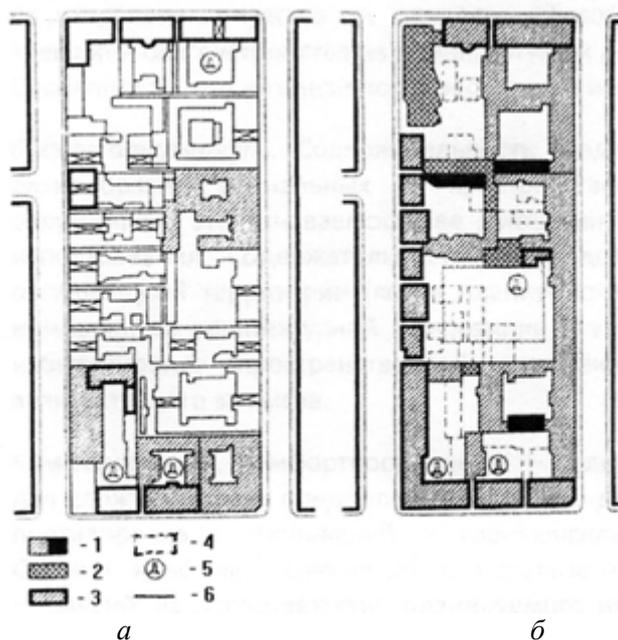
Проект реконструкции одного из кварталов: а – опорный план; б – проект реконструкции (проектная плотность жилого фонда – 9 400 м²/год); 1 – здания после капитального ремонта и модернизации; 2 – новое строительство; 3 – здания, в первых этажах которых размещаются учреждения культурно-бытового обслуживания; 4 – подлежащие сносу корпуса и части зданий; 5 – детские учреждения; б – границы участка детского учреждения
